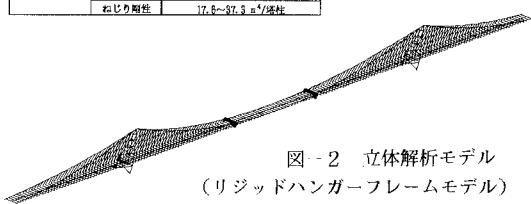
立体解析モデル (リジッドハンガーフレームモデル)
